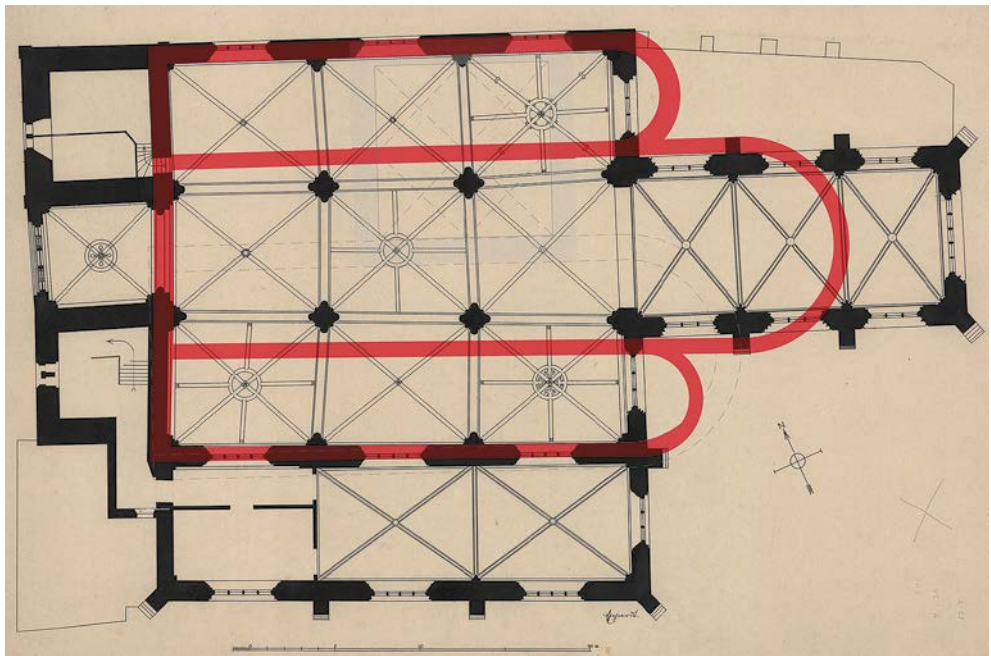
Unser Lieben Frauen, Grundriss Bau III um 1160
